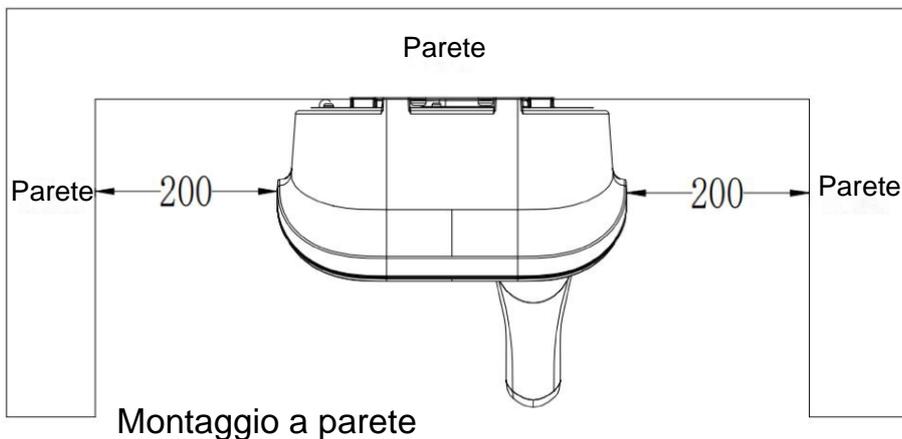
Schema delle distanze di manutenzione per il montaggio a parete
